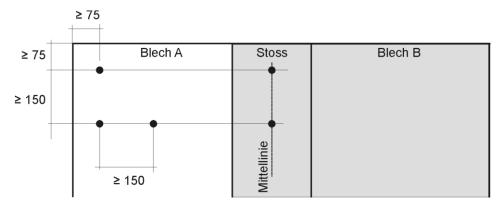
Beschussorte im Grundriss für Flachblech (Masse in Millimeter)
